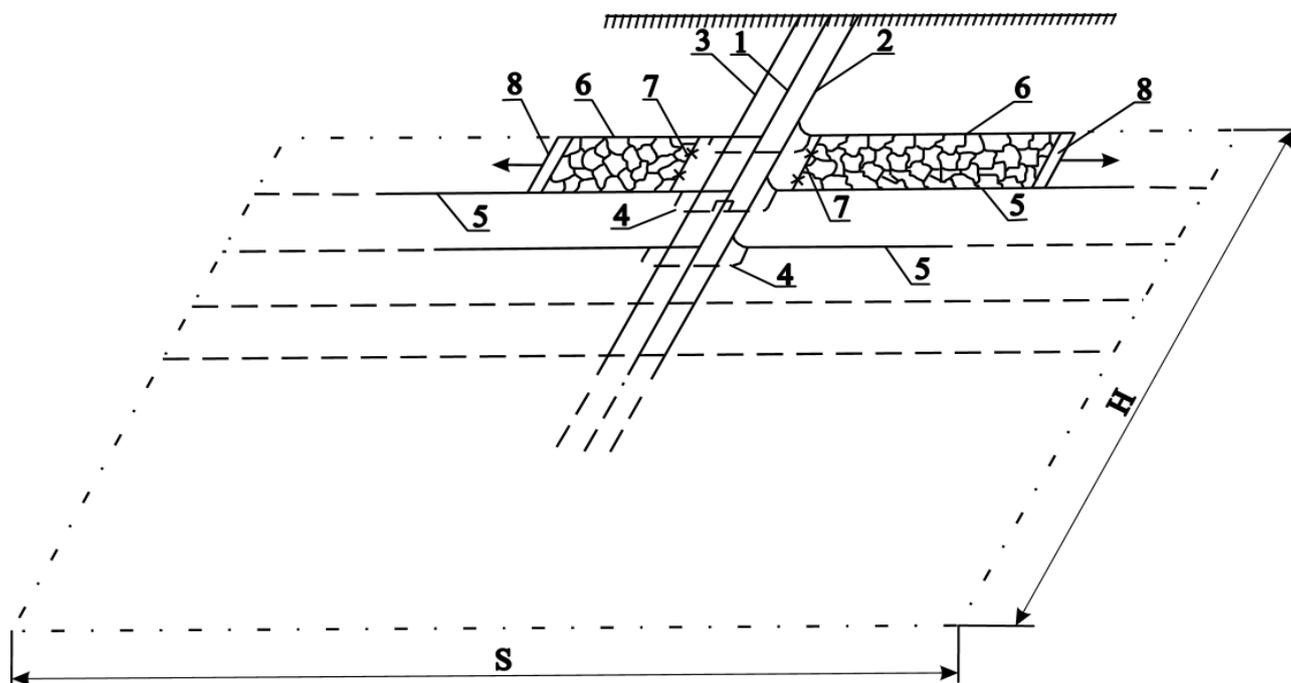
Схема розташування виробок при розтині вугільного пласта вертикальними стволами та поверховими квершлагами
